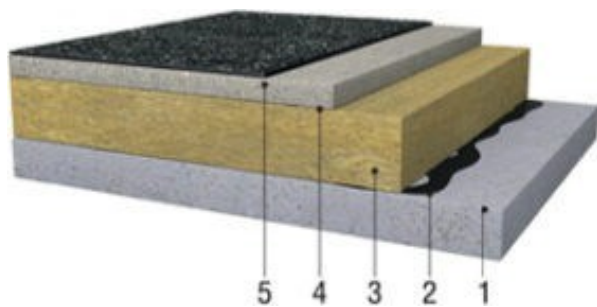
Схема утеплення перекриття..... Рис. 25 Зразок заливки перекриття
